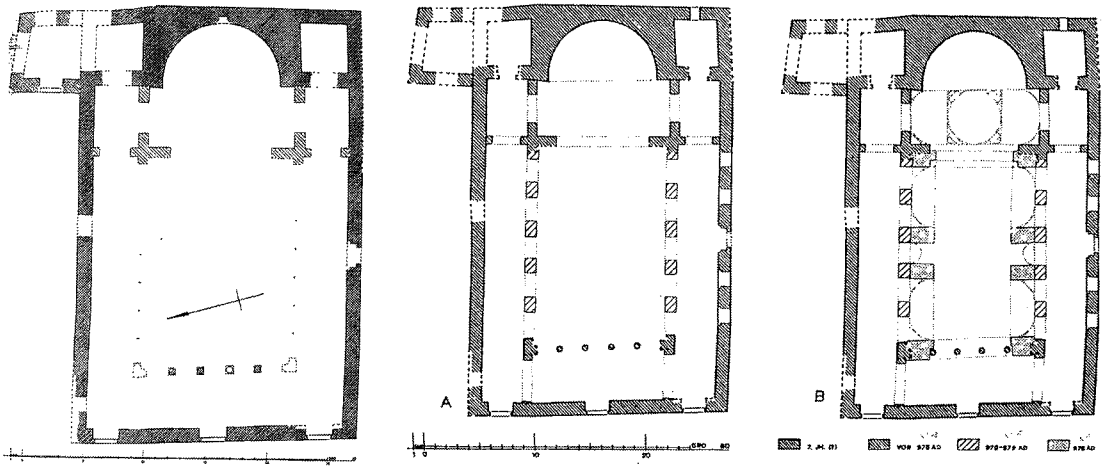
مسقط أفقي لكنيسة السيدة العذراء الدمشقية.
